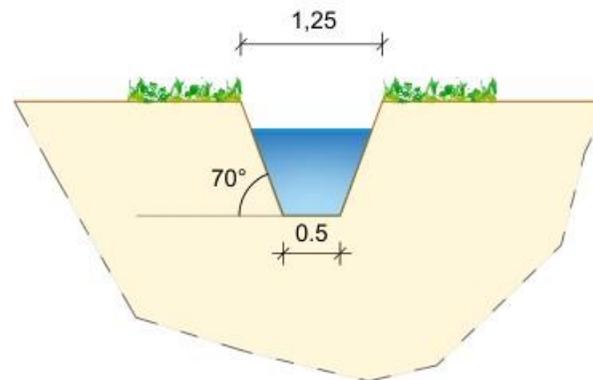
Sezione tipo dei nuovi canali di drenaggio
